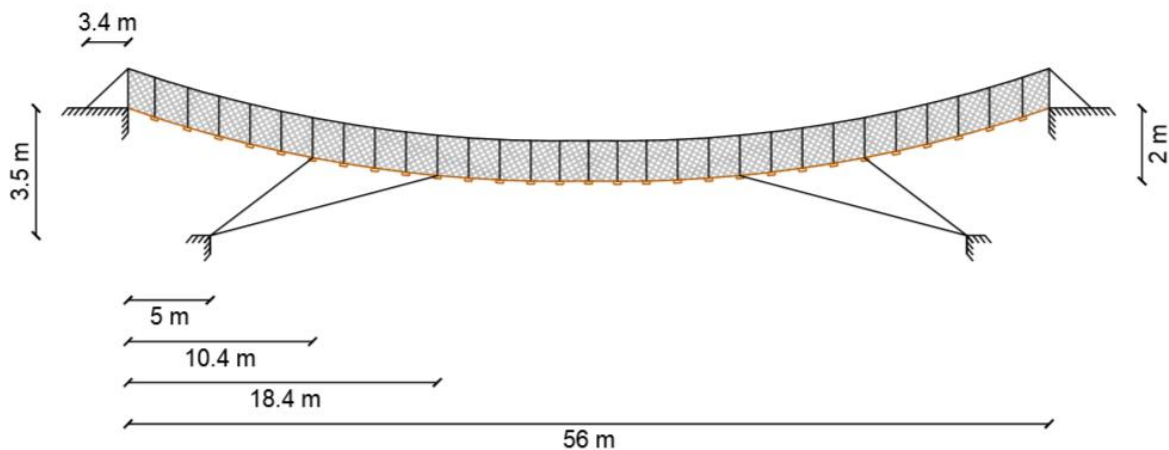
Dimensões da ponte em estudo em Alçado.
